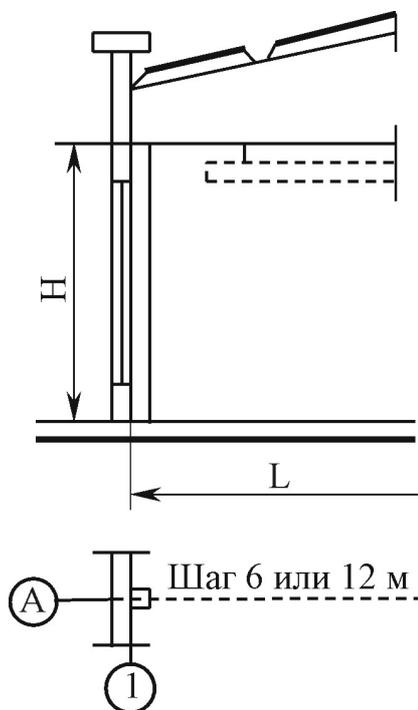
Схема привязки колонн и стен каркасного здания с подвесными кран-балками к координационным осям
